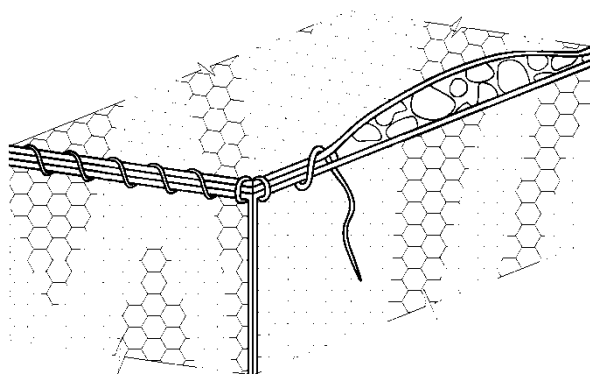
Установка крышки на коробчатую габионную конструкцию
